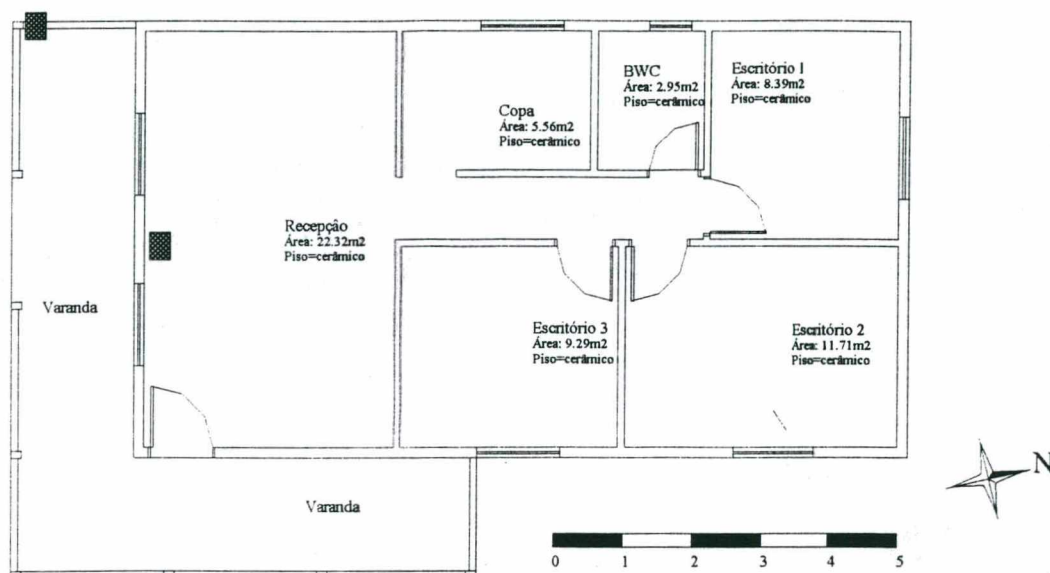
Planta Baixa Pavimento Térreo Casa 4.
